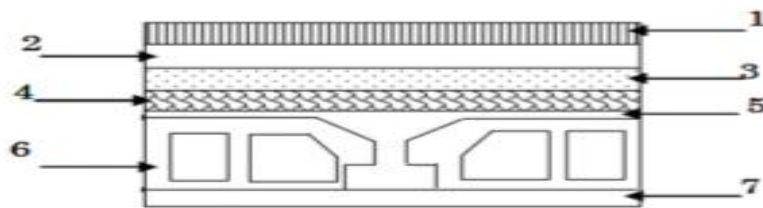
coupe transversale d'un Plancher Terrasse inaccessible
